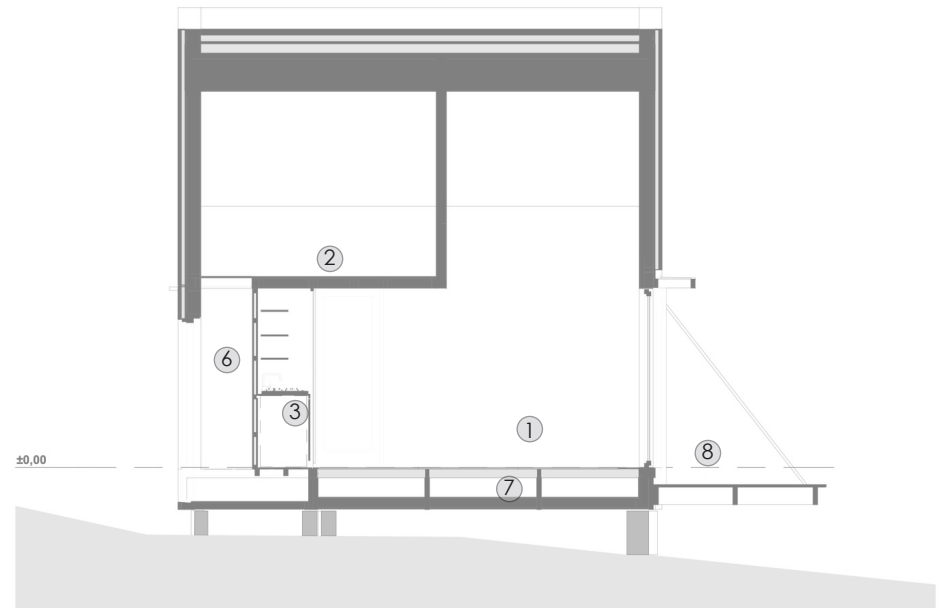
Sección Longitudinal. Fuente: ArchDaily, 2020
